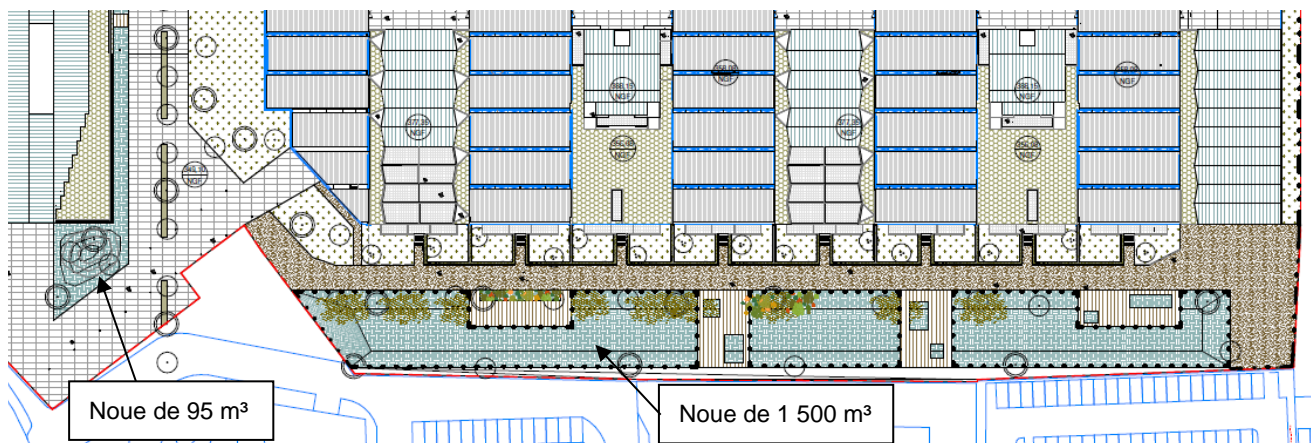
Vue en plan des 2 noues paysagères (source : ANMA)
